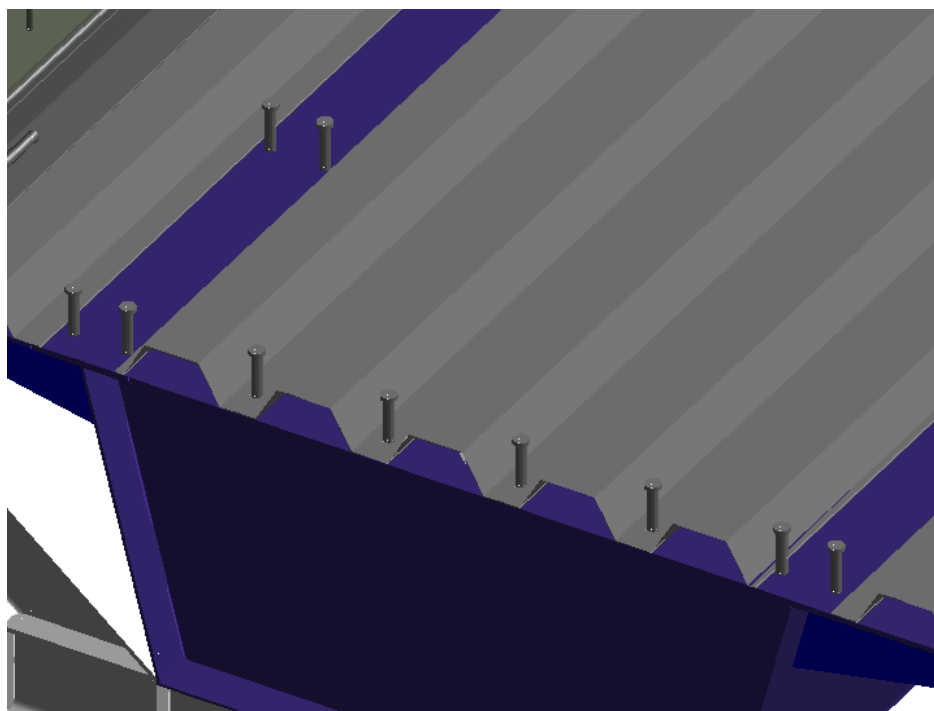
Detalle conectadores en chapa colaborante y viga cajón
